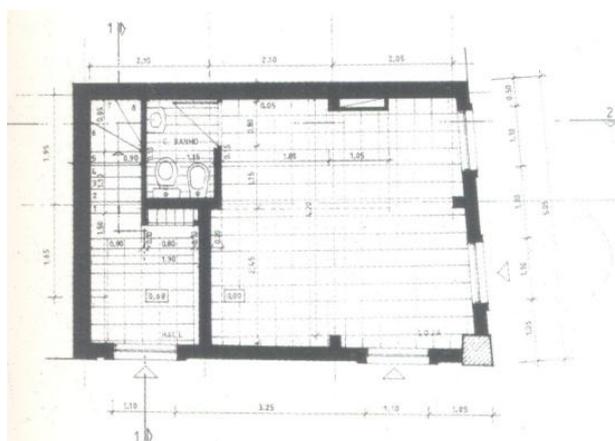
Planta do térreo na travessa do Poço da Cidade nº 52-54. LISBOA, 1993, p.103.
